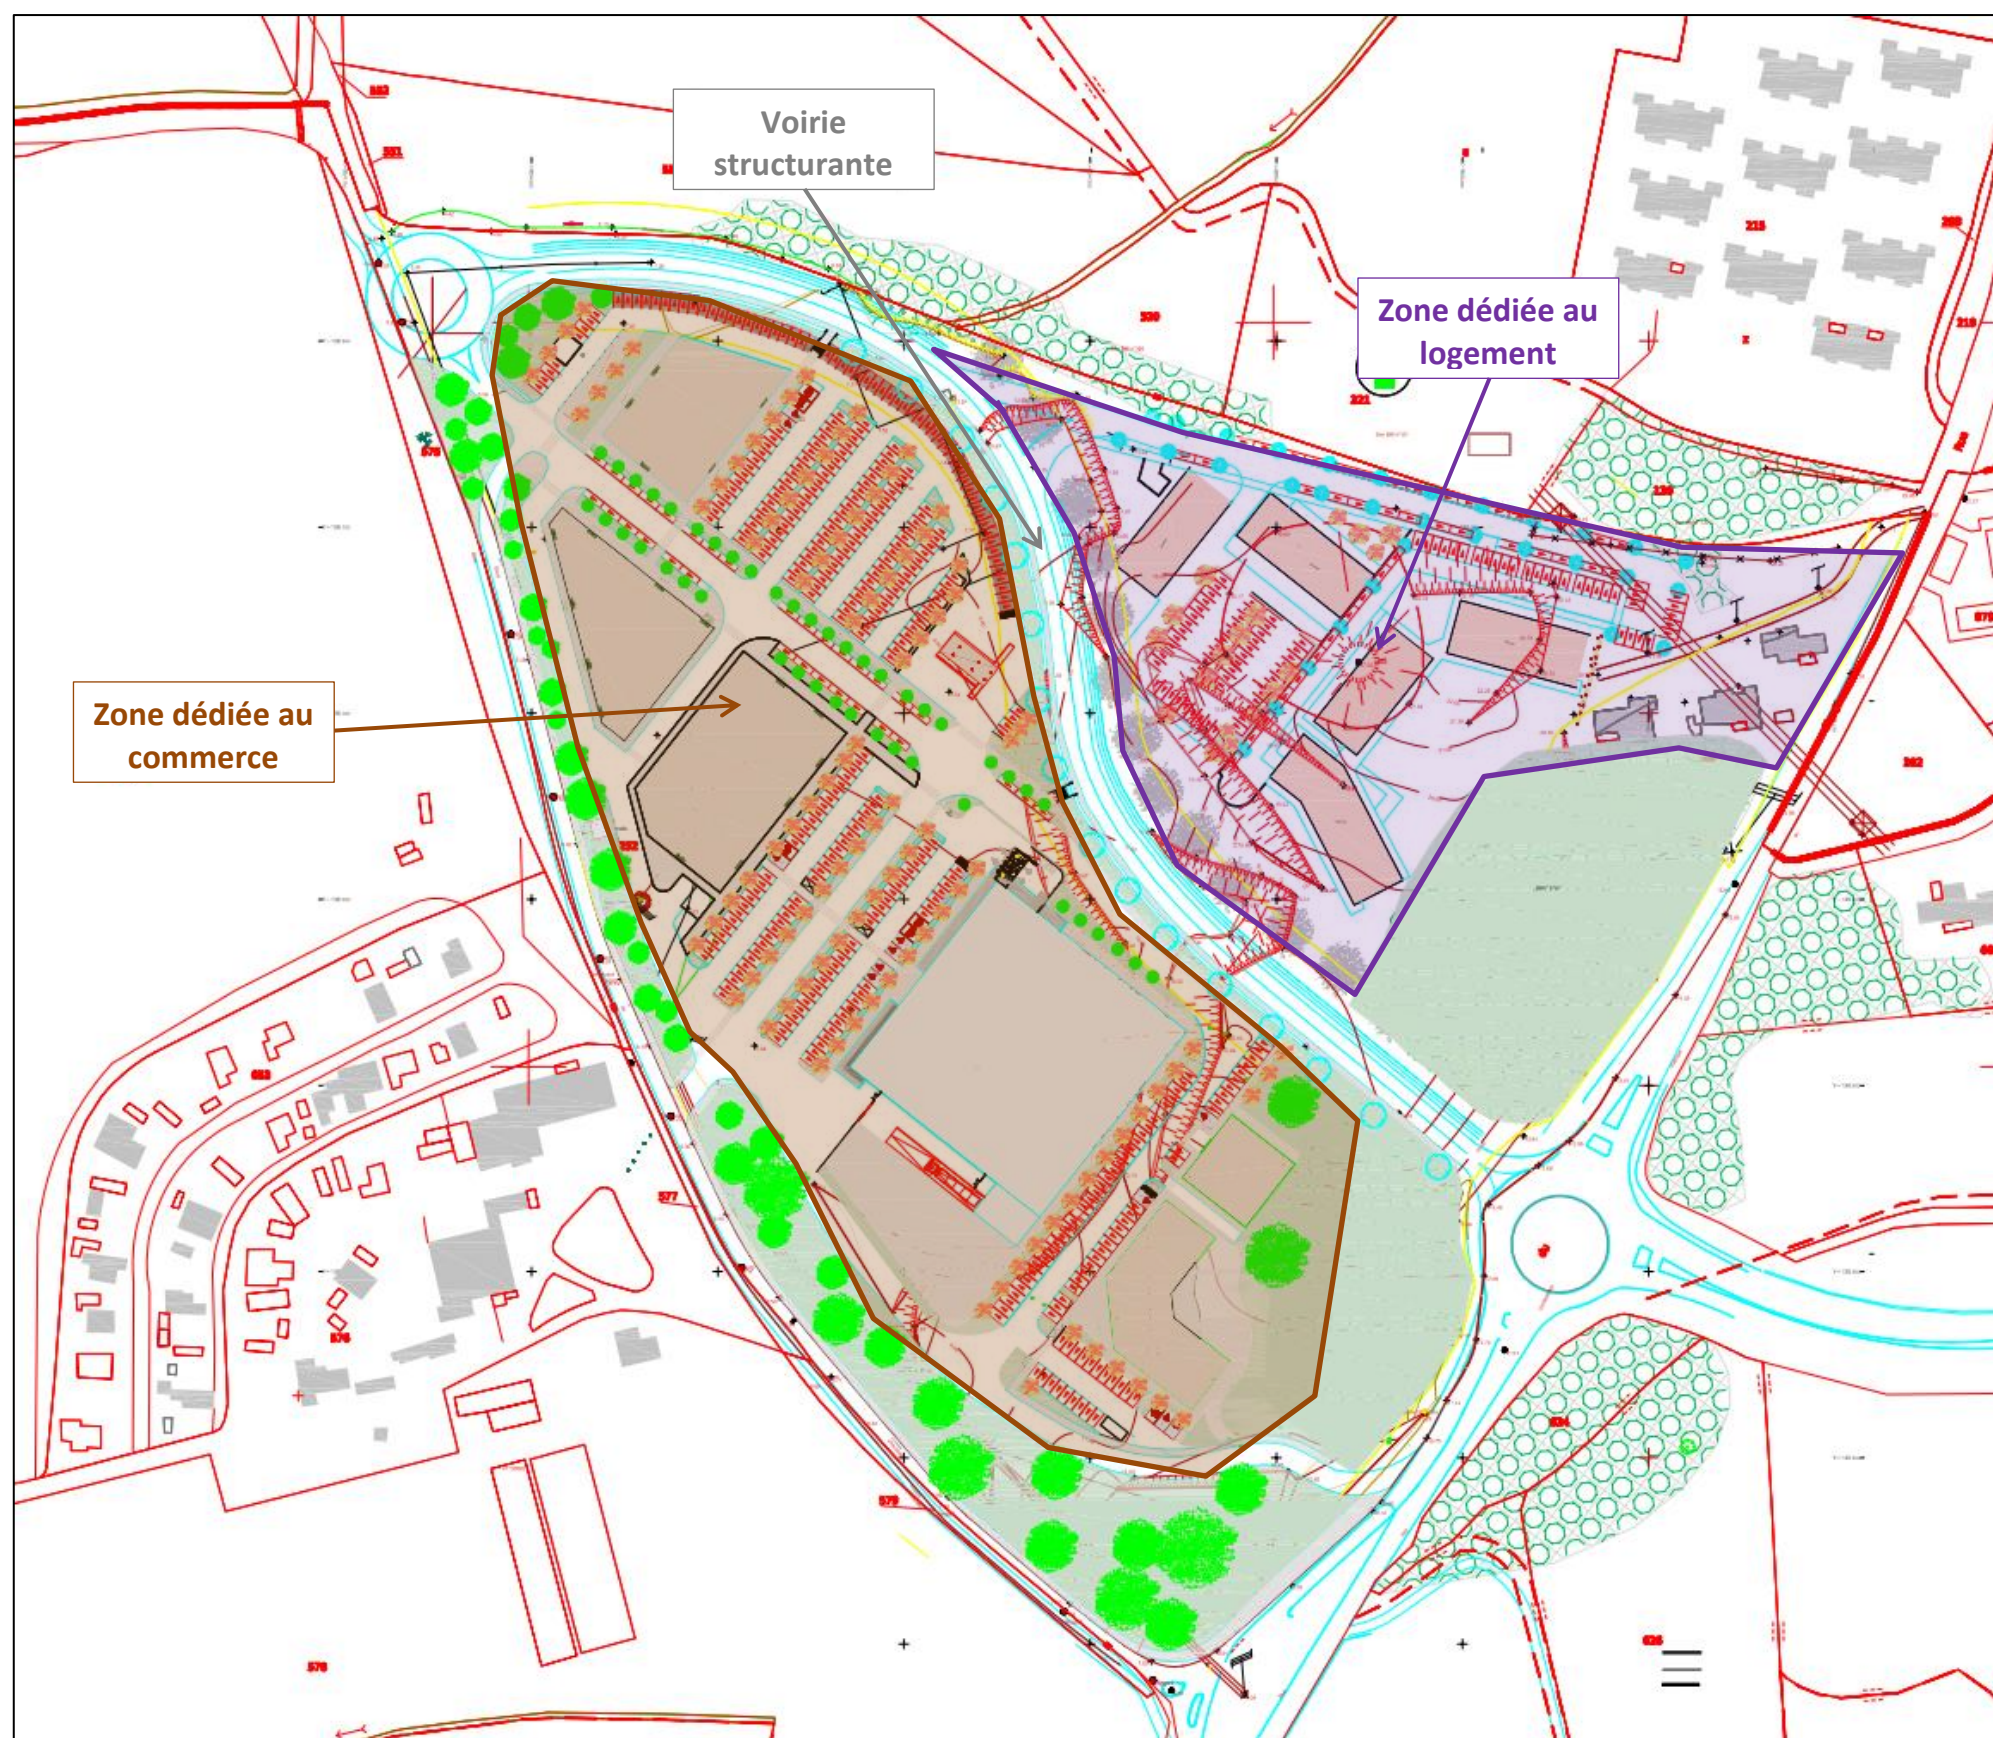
Plan de masse de projet – (source : Techni Architecture)
